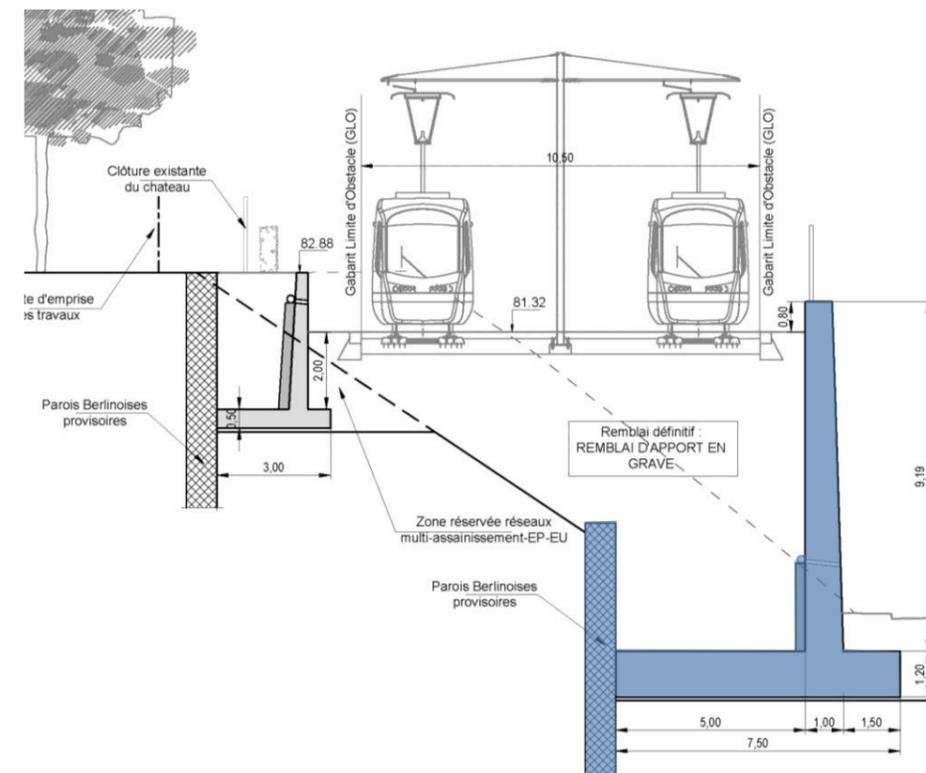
Coupe transversale du mur bas (Source : AVP- juillet 2015)
